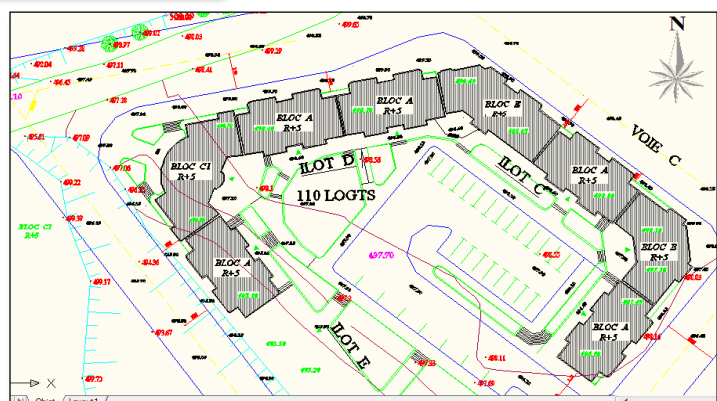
Plan de masse de 110 logts LSP (voir annexe A)
